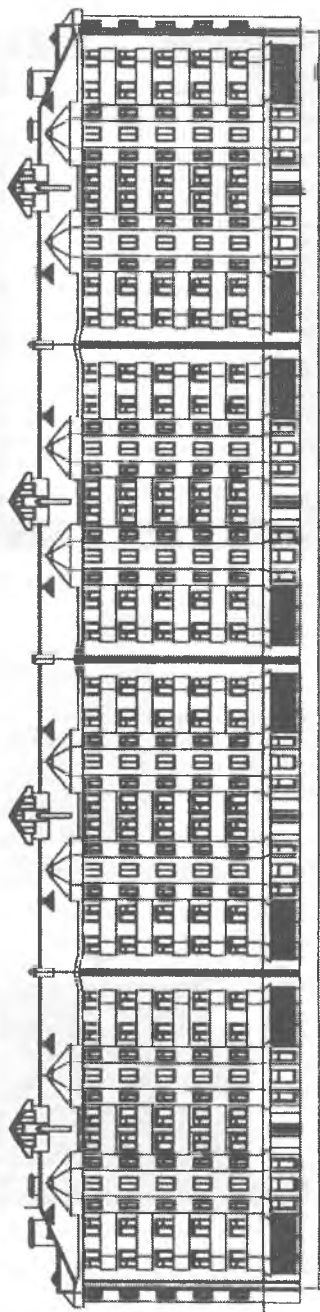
Фасад экспериментального дома с эркерами. На первом взгляд, в экстерьере дома отсутствуют «этнические компоненты». Однако конусообразное купольное завершение эркеров должно символизировать круглое в плане кочевое жилище. На верхнем этаже «круговая», т. е. эркерная, часть имеет высоту 4,5 метра, что создаст в помещении эффект интерьера кочевой кибитки калмыков.
